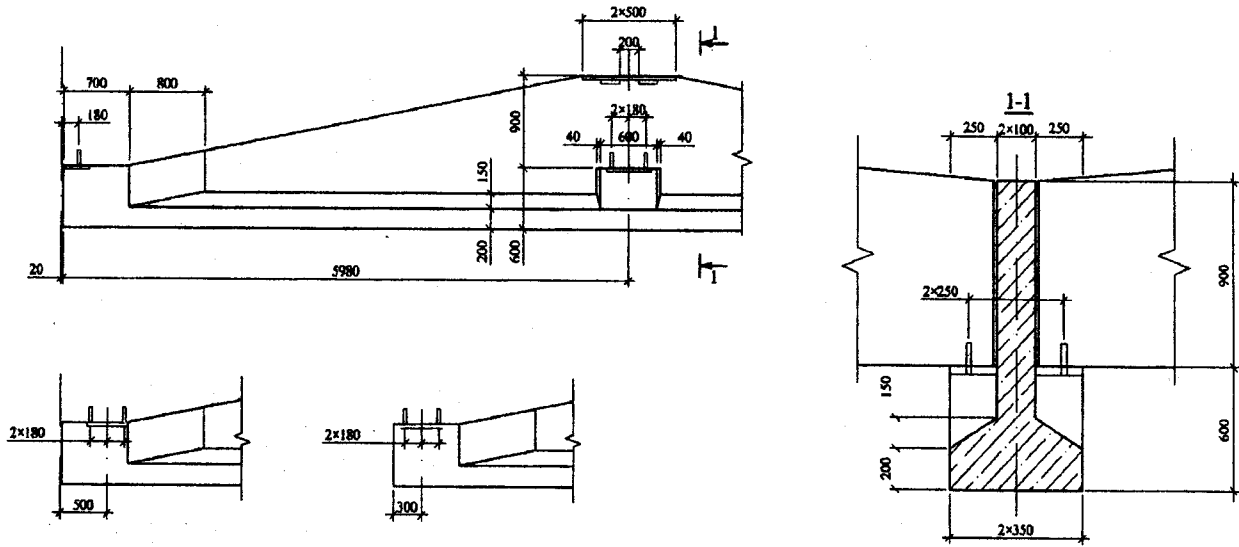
Подстропильные балки для зданий со скатной и плоской кровлей
